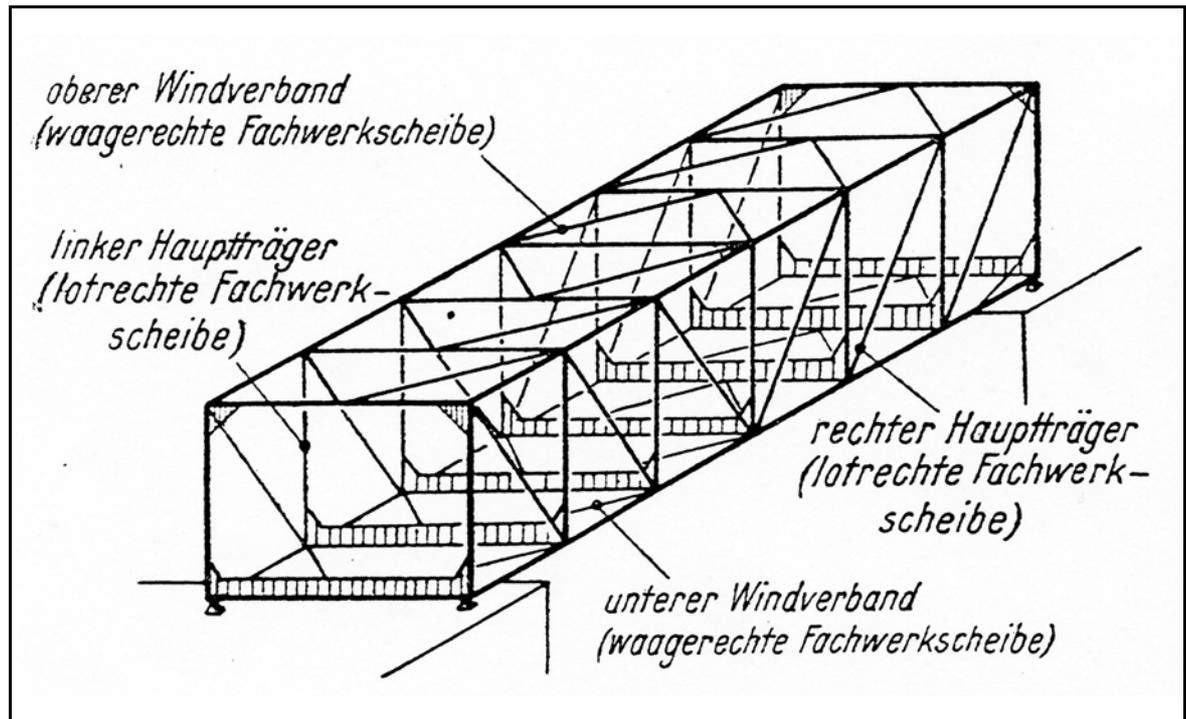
Konstruktionselemente einer Stahlfachwerkbrücke [29]
